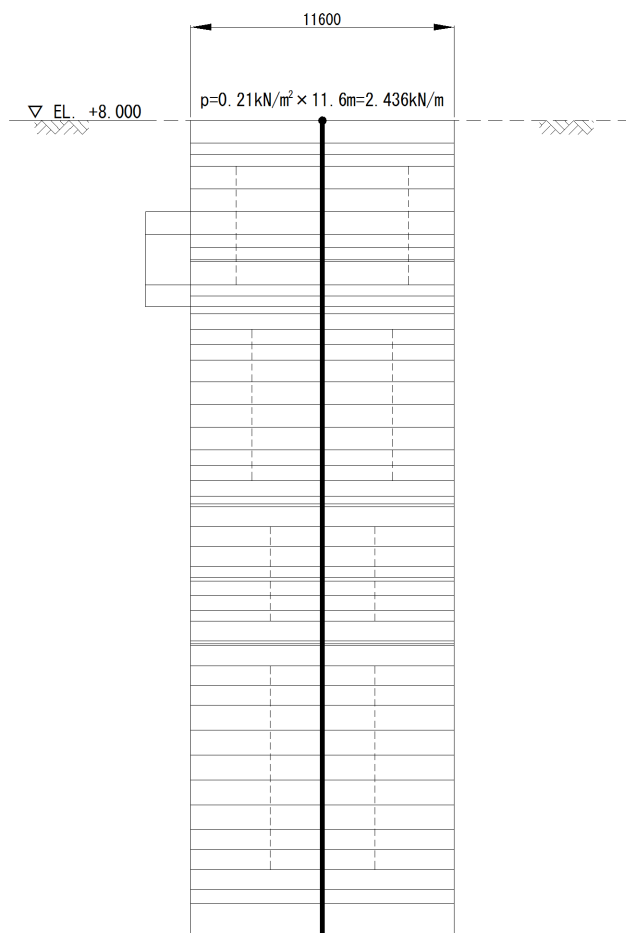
(1) 雪荷重図 (東西方向断面)
